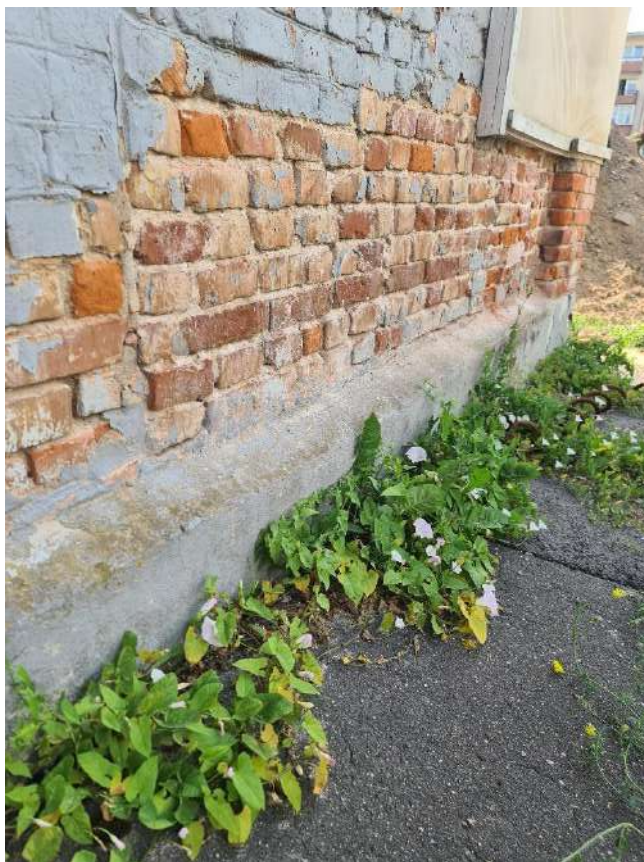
Разрушение отделочного слоя наружной стены в осях 4/Б-А
